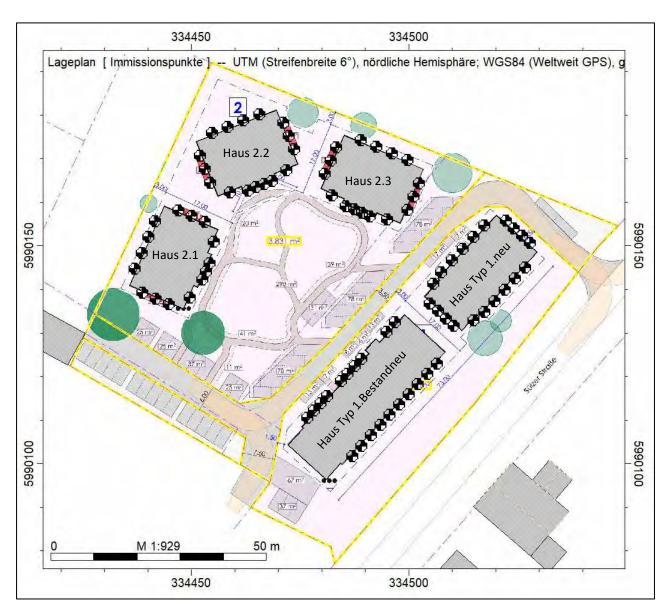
Lageplan der Immissionsorte und Gebäudezuordnung
